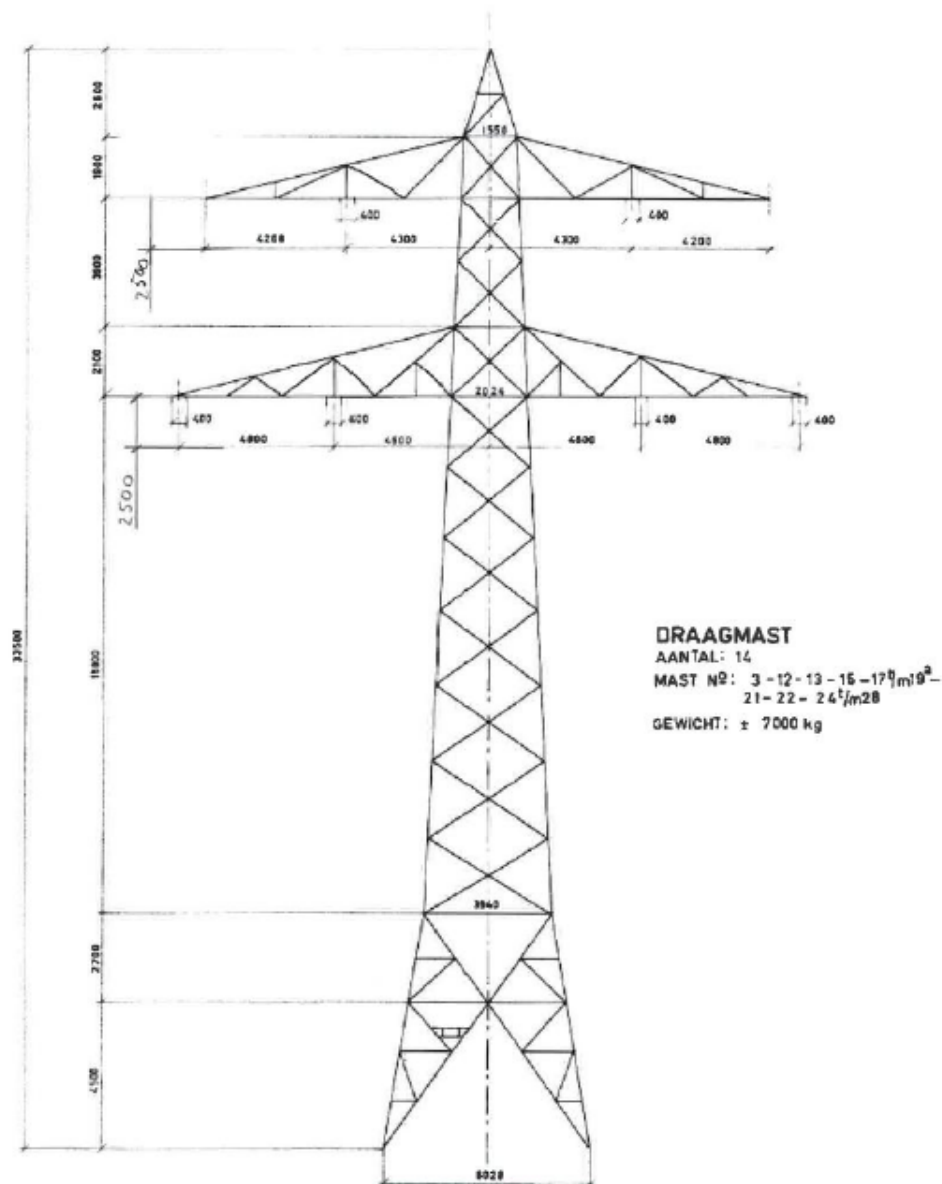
, Mastheeld masttype 380kV S+9 met V-kettingen
